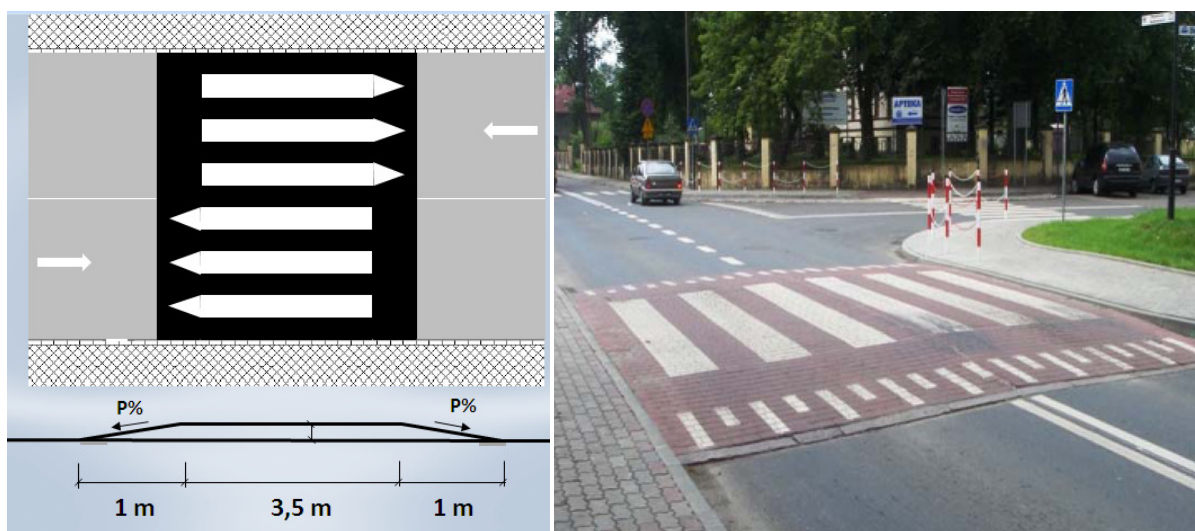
Esempio di attraversamento rialzato prefabbricato
